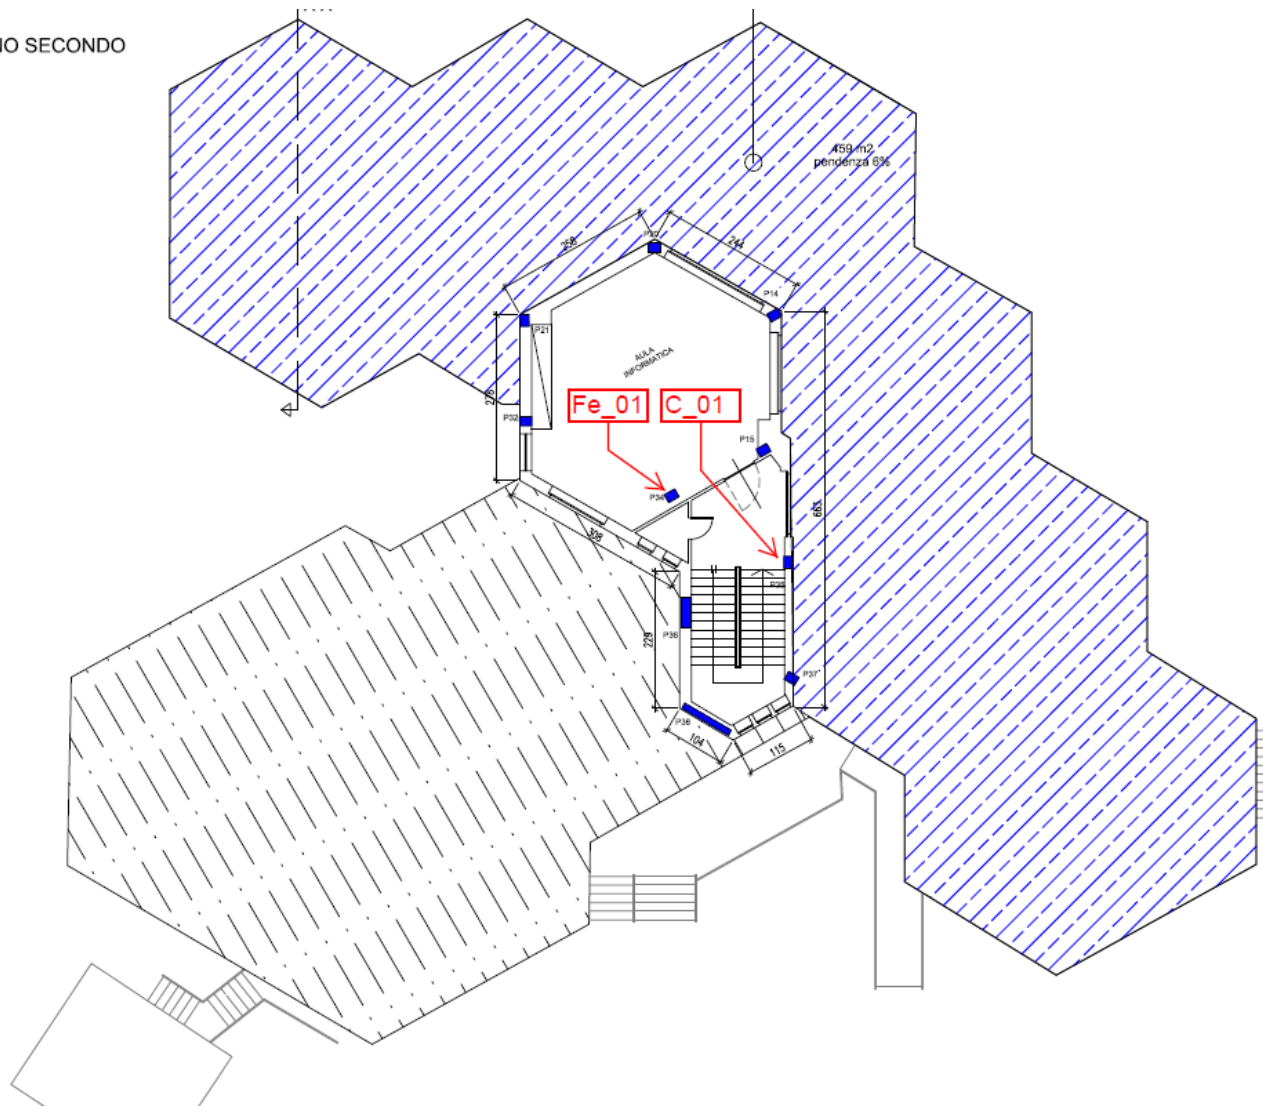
Localizzazione delle posizioni dei prelievi - plesso A - piano secondo
